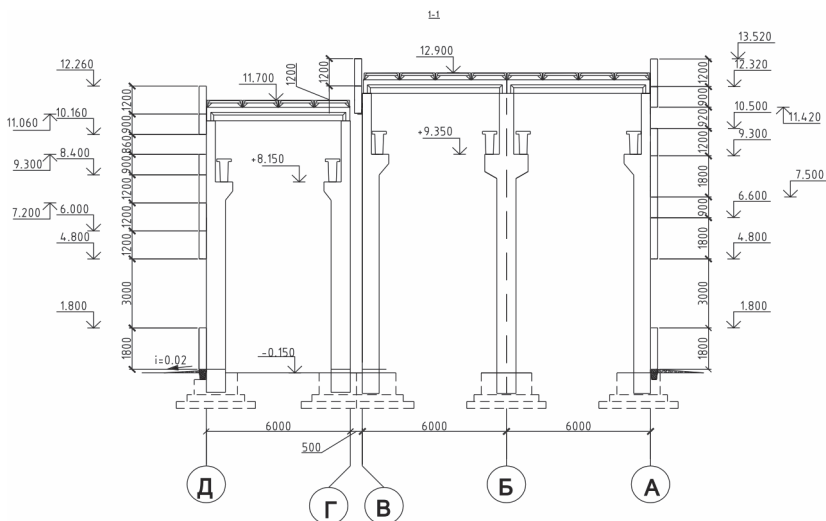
Поперечный разрез трехпролетного одноэтажного промышленного здания
